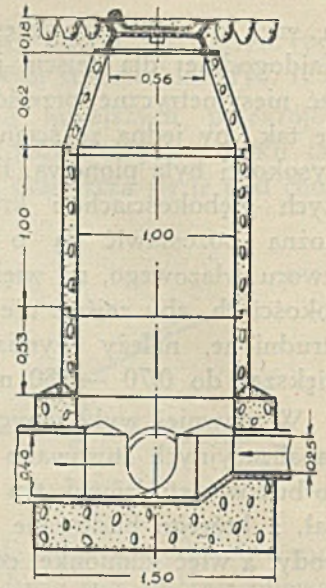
Studzienki zjazdowe na sieci rozdzielonej.
